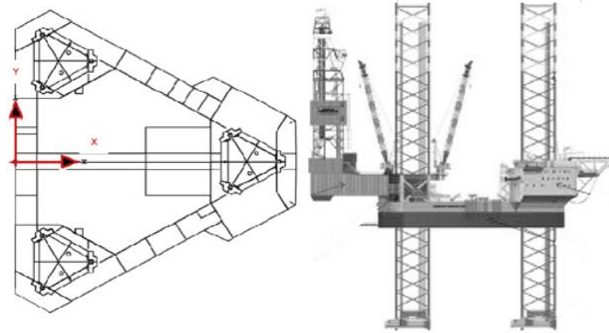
Plataforma auto – elevable "Jack-Up " vista en planta y perfil tomado de (Yeol Ma, Kim, Park, Lee, & Seo)
